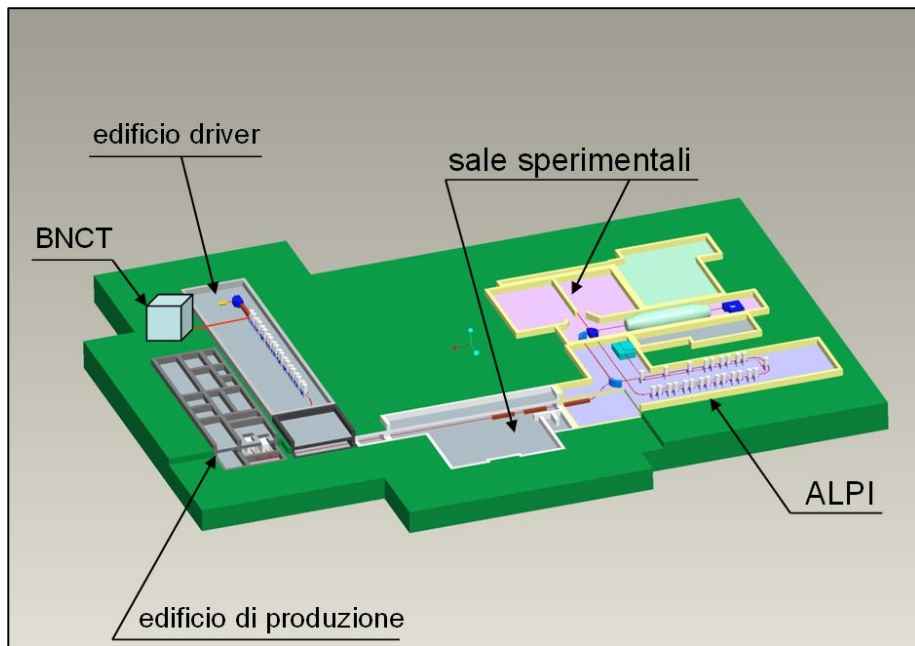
Vista generale degli edifici dell'installazione SPES
